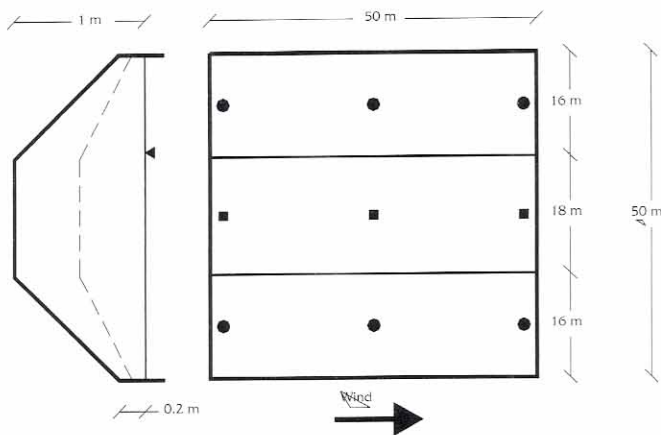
Sezione verticale (sinistra) e pianta (destra) del bacino a pianta quadrata
